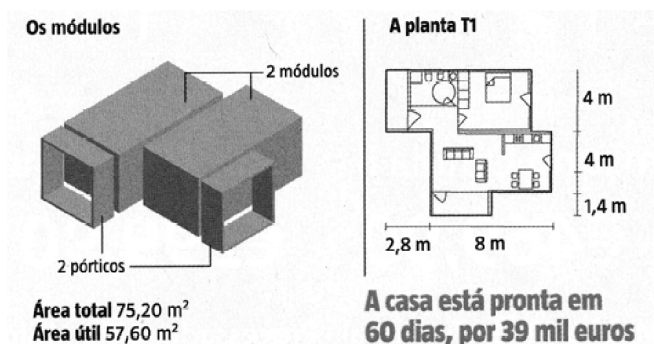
Planta de tipologia T1 sistema Sit Urban Design, SÁBADO (2009)
